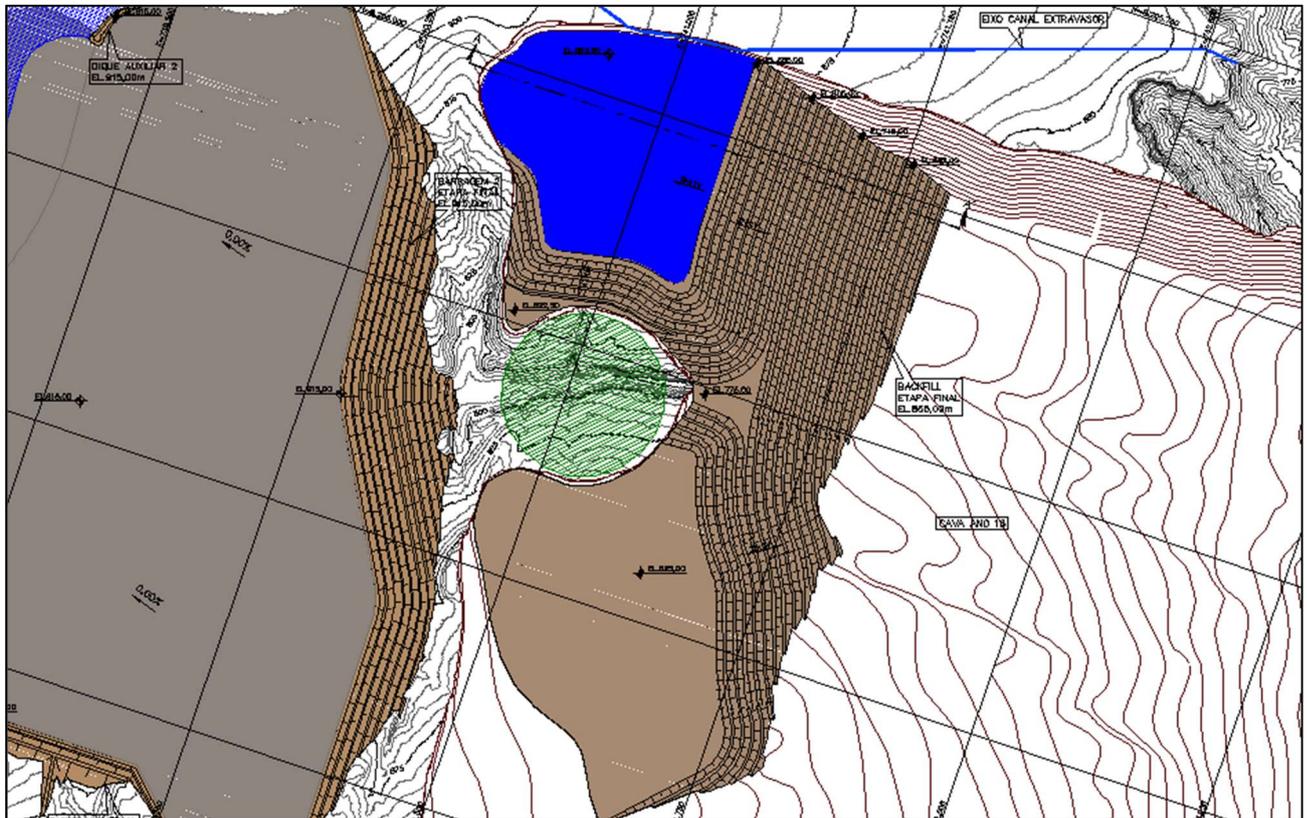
Arranjo Geral do *Backfill* – Projeto Bloco 8.
